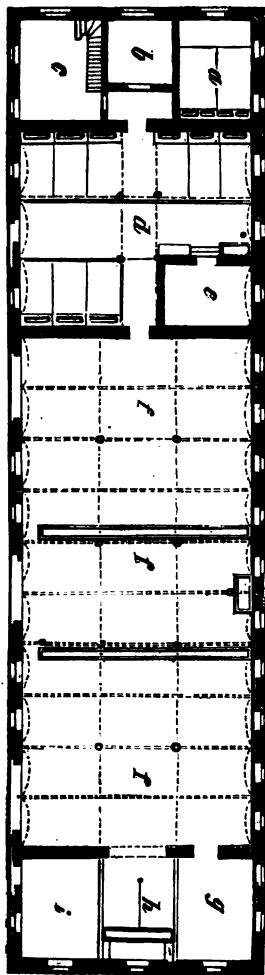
Rindvieh- und Pferdebestall-Gebäude, Grundriß.
